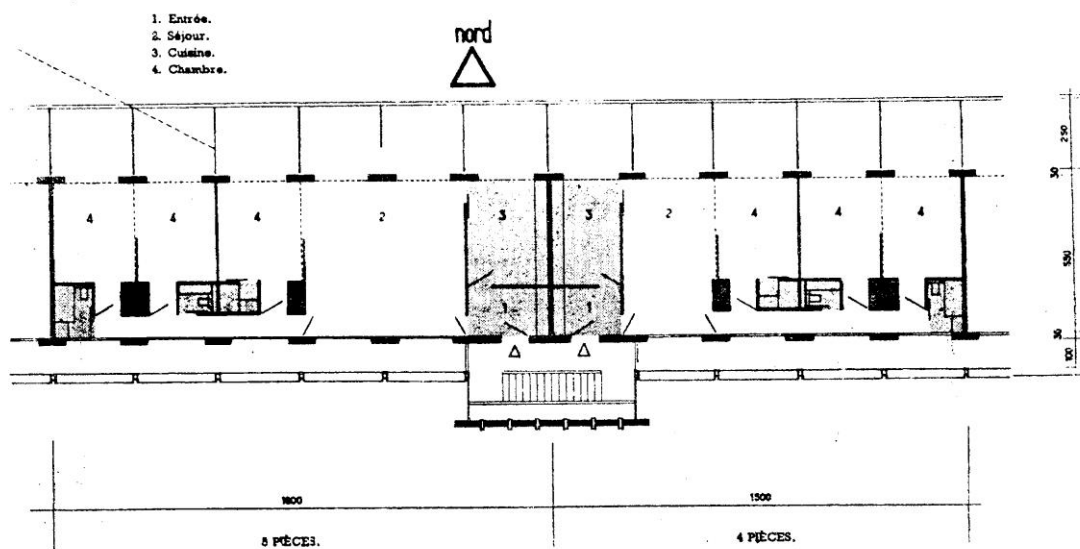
7 Plan proposé pour le logement collectif, source CSTB
